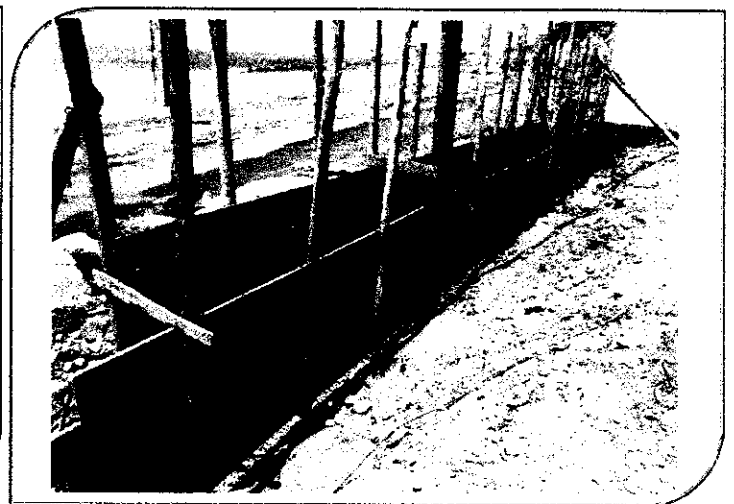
Se Realizó el encofrado de Cimiento Corrido h=0.60m.y de ancho a=.50m, concreto C:H 1:10 + 30% P.G.
